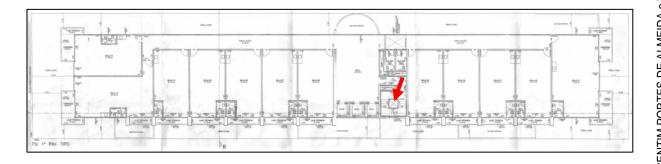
Primeiro pavimento. Destaque para o shaft de prumadas.
